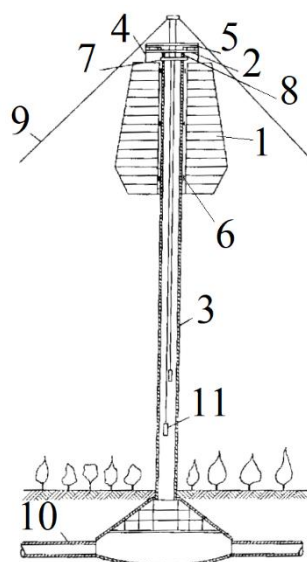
Подвесное многоэтажное здание: 1 – перекрытия этажей; 2 – опорное кольцо; 3 – несущий ствол; 4 – стальные канаты; 5 – блоки; 6 – амортизаторы; 7 – оголовок; 8 – подшипники; 9 – оттяжки; 10 – пустотелый фундамент; 11 – шахта для лифтов
